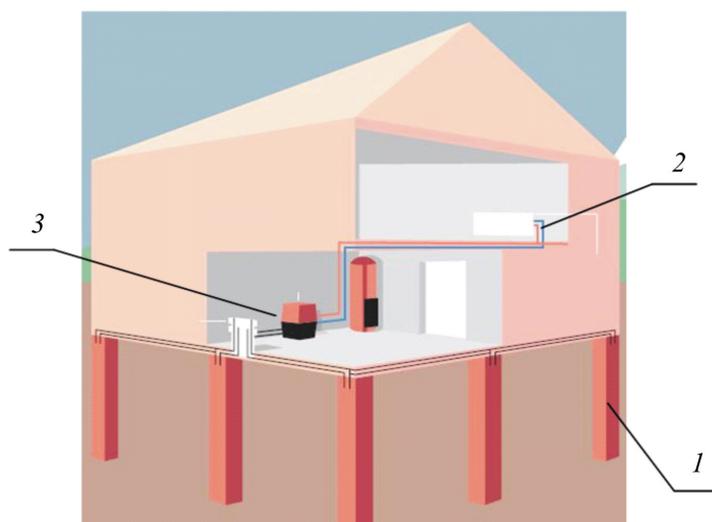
Принципиальная схема систем с использованием тепловой энергии грунта: 1 – энергоэффективный фундамент; 2 – система отопления или кондиционирования здания; 3 – тепловой насос
